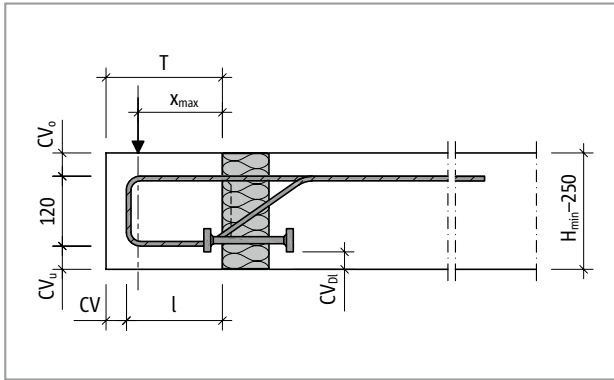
Schöck Isokorb® T Typ O-X80: Produktschnitt
